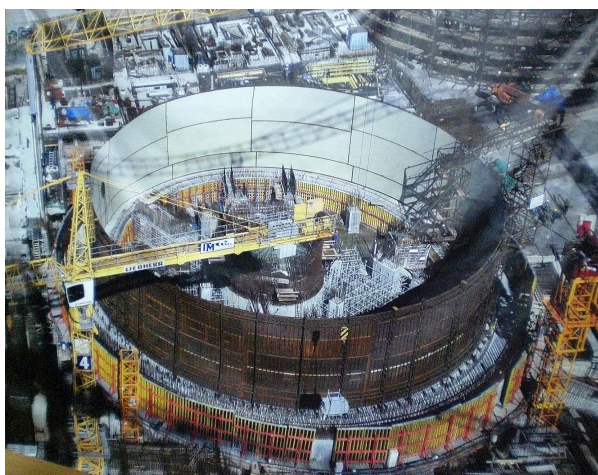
Ukladanie 3. prstenca containmentu v prevádzke Sanmen 1
